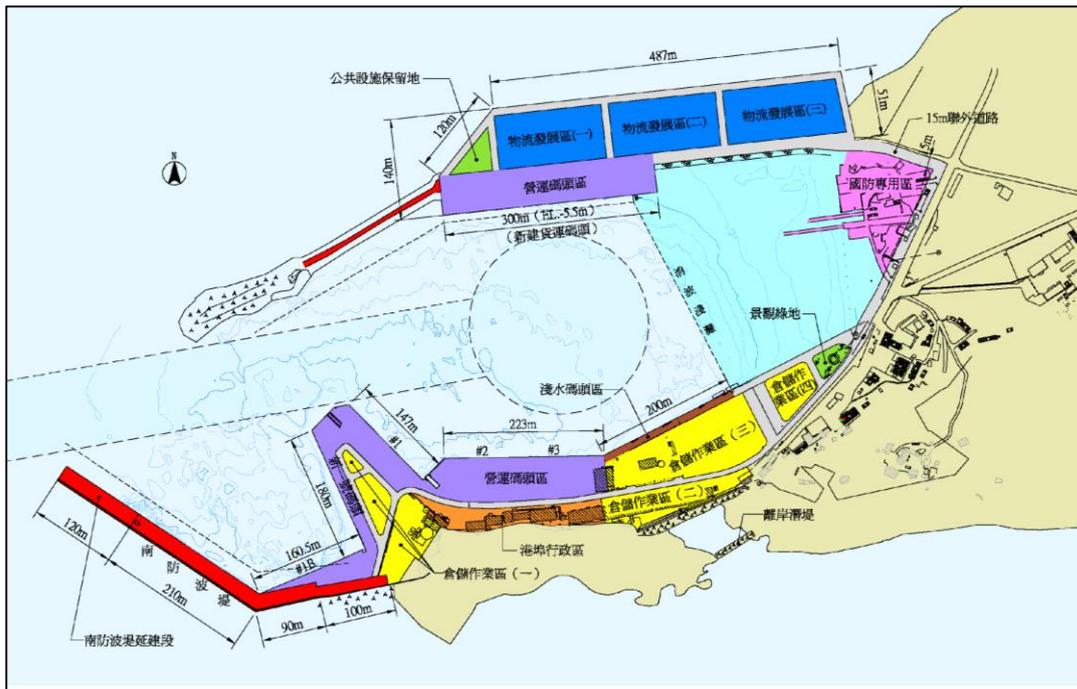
料羅港區碼頭及防波堤平面配置圖
